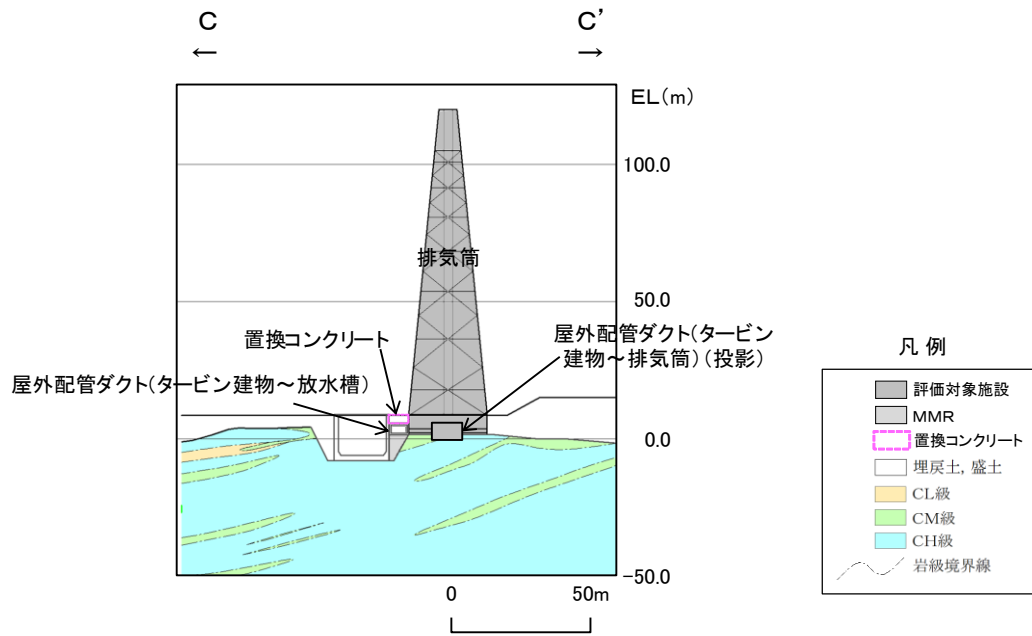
排気筒等の地質断面図 (C-C' 断面)
